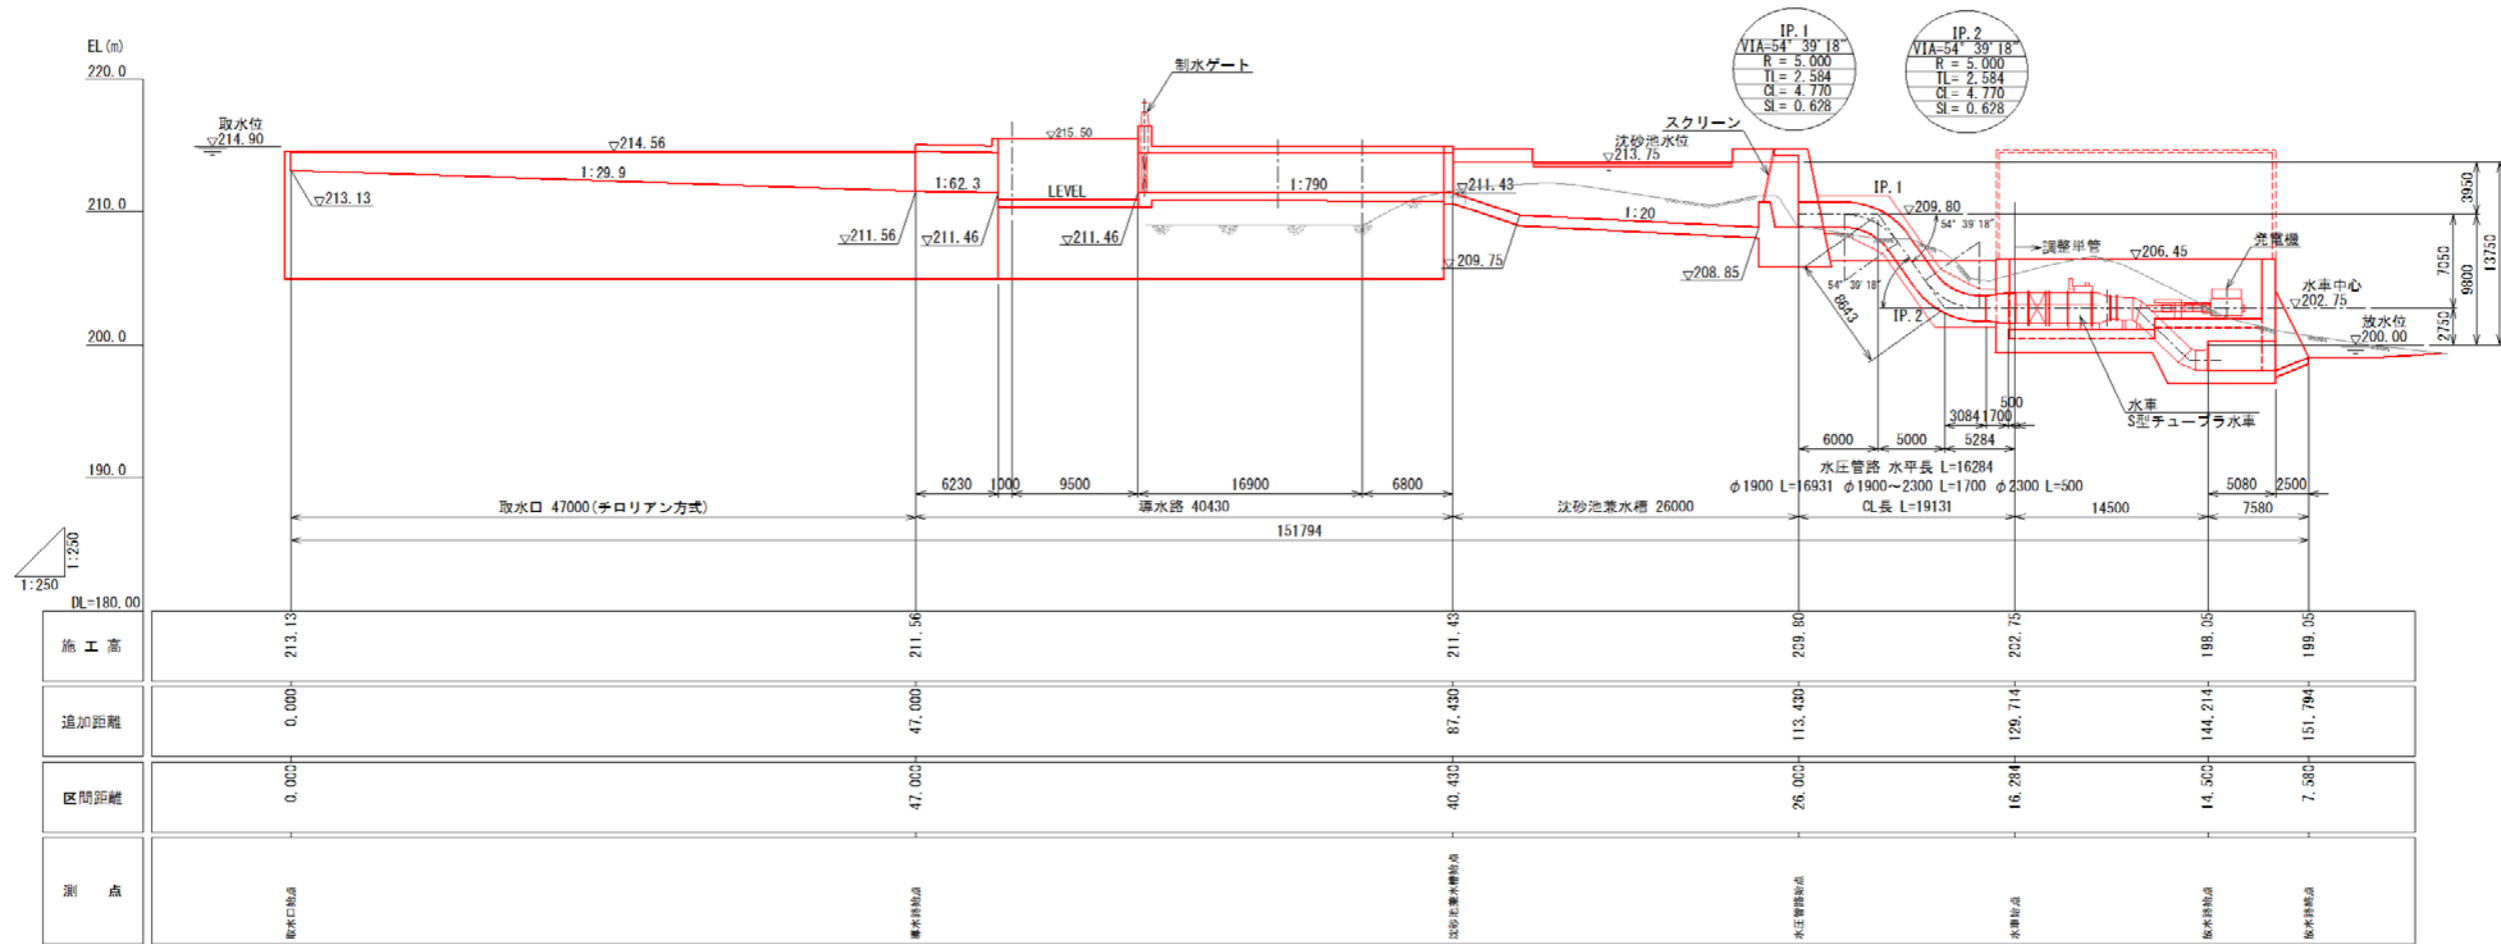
水路縦断面図 (安丸地点) NO-SCALE
